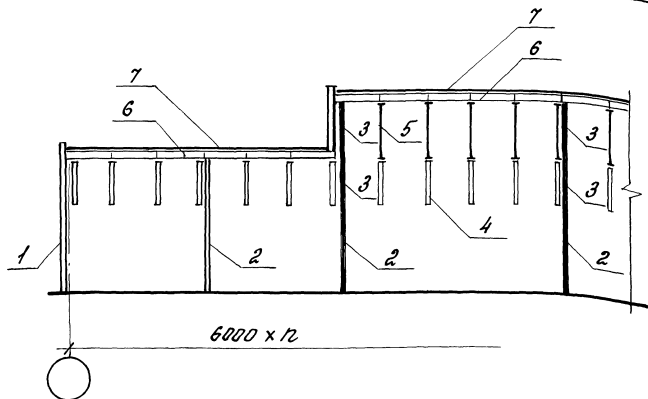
Пример расположения противопожарных перегородок в разрезе здания с ограждающими конструкциями стен и покрытий из негорючих материалов
